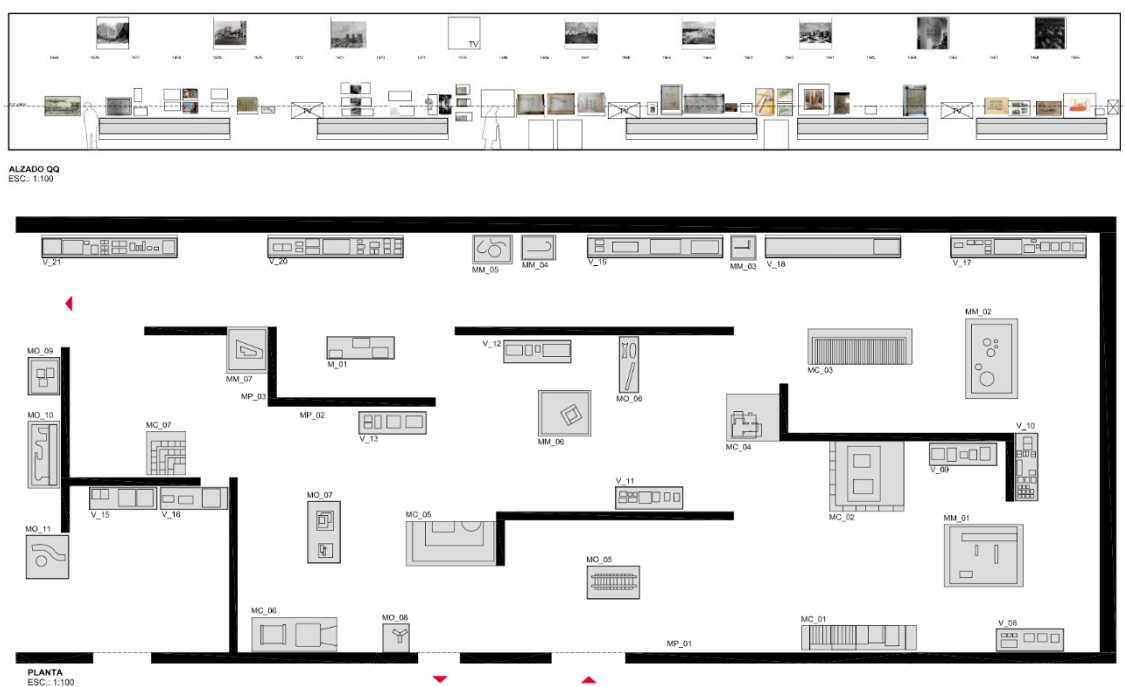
Planta de «La Gran Sala» y Alzado del muro de la vivienda _ Planta y Alzado Esc.: 1/200_ *Latin America in Development: 1955-1980*. Documento realizado por el autor.2020.
